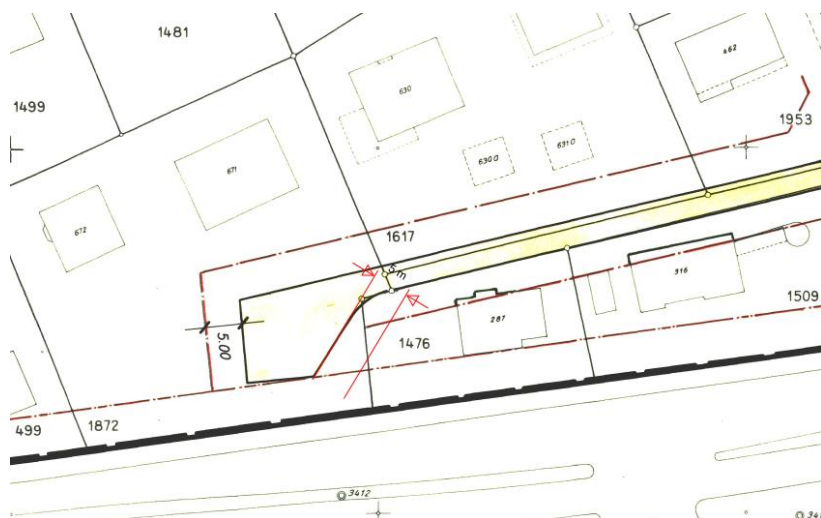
Rechtsgültiger Erschliessungsplan für Wendehammer Eigasse RRB Nr. 406 vom 22.04.2000.
